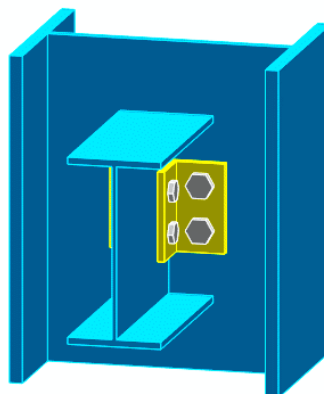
Vue 3D de l'assemblage poteau-poutre maitresse
